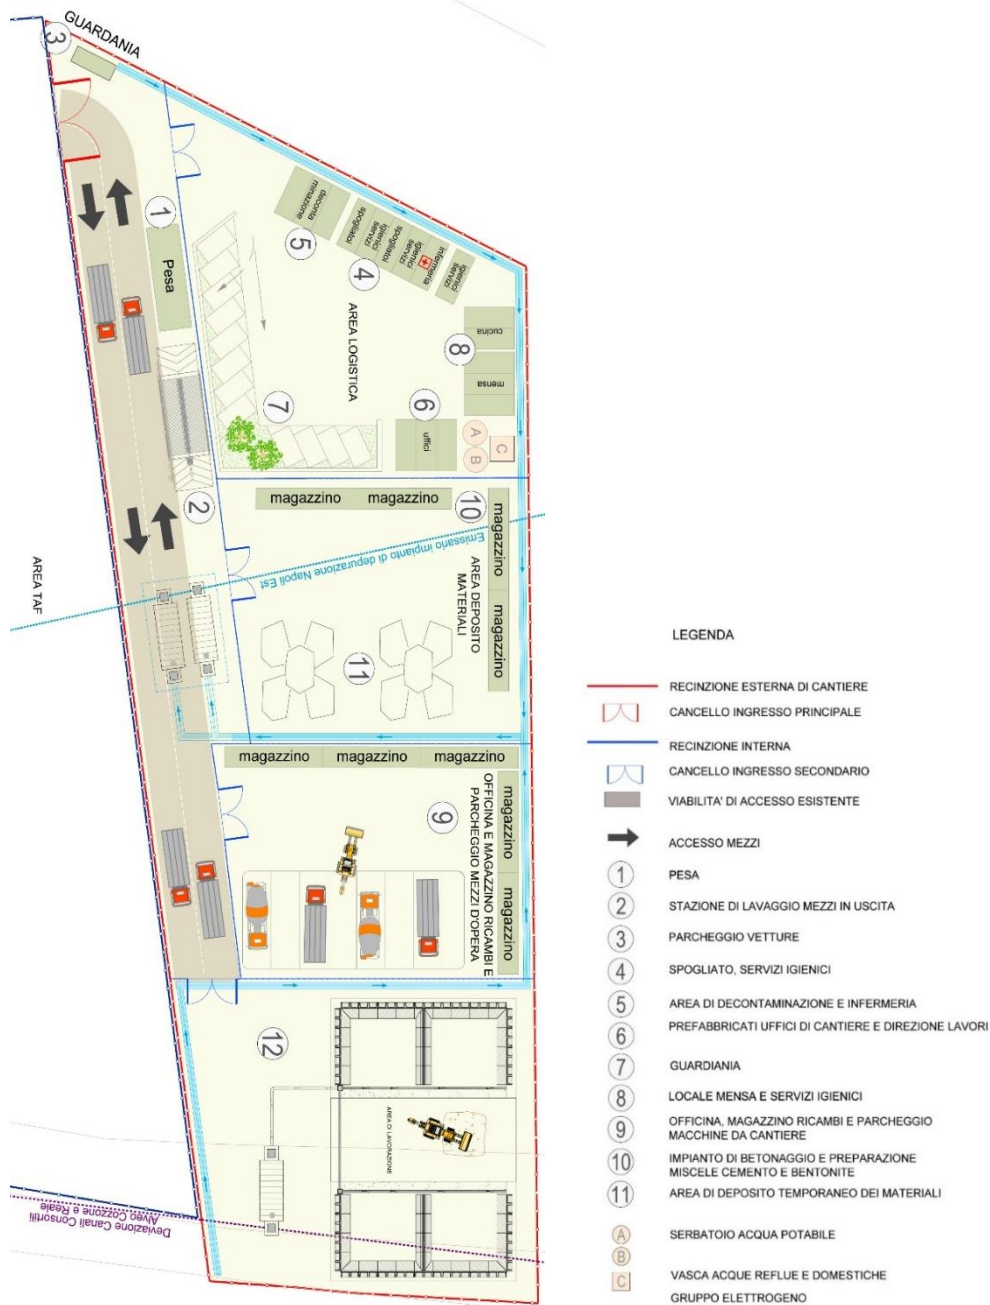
Planimetria generale dell'area logistica e di cantiere.
